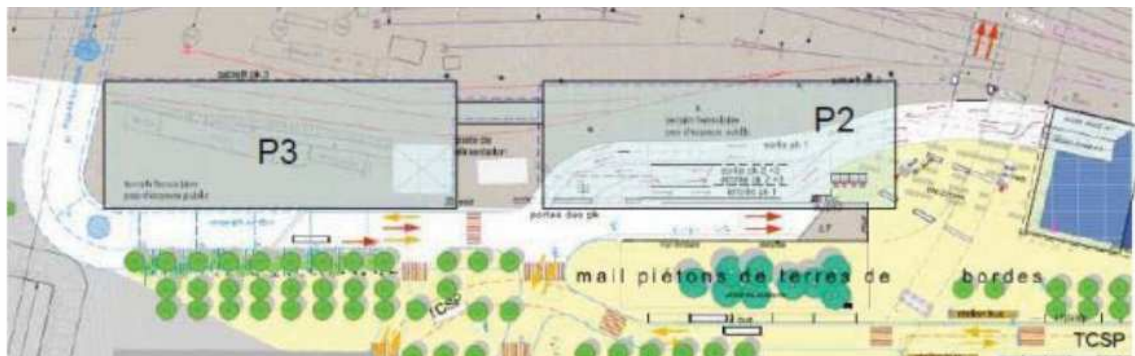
Plan des parkings P2 et P3 (étude d'impact, page 206)
